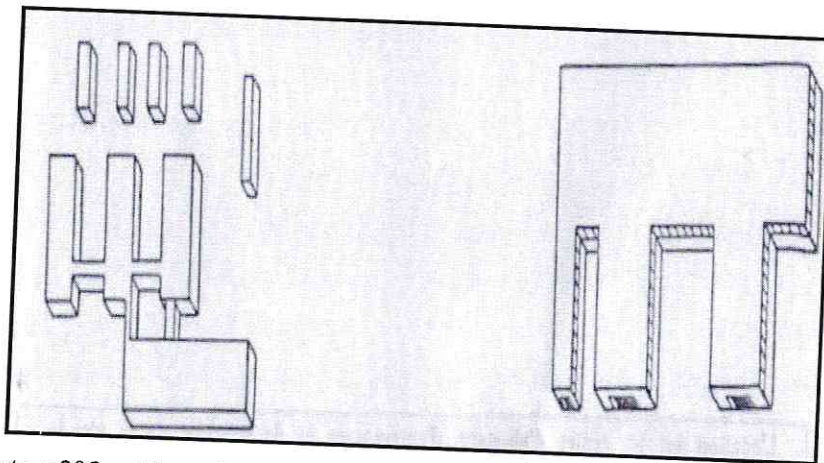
Abattoir pavillon et abattoir bloc (Debrot S, Constantin A, 1968)
